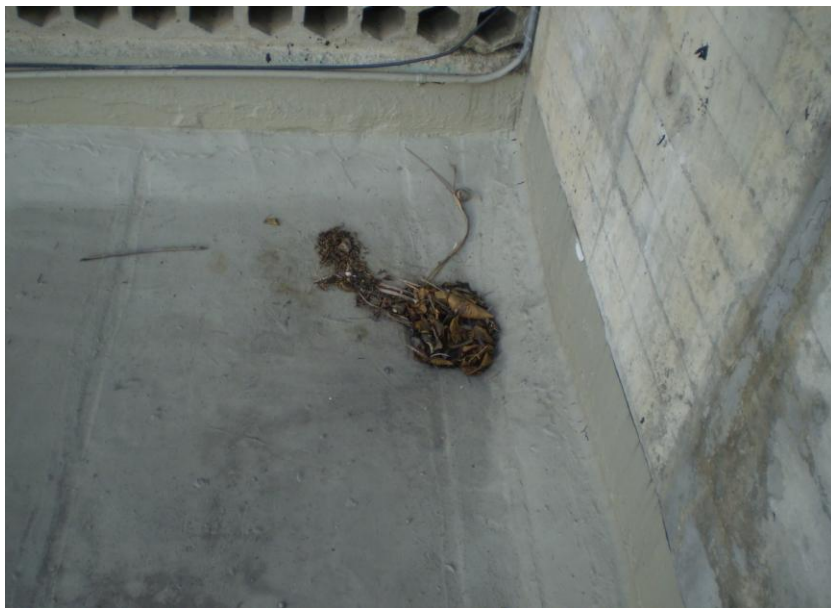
Acumulación de hojas obstruyendo el drenaje.
